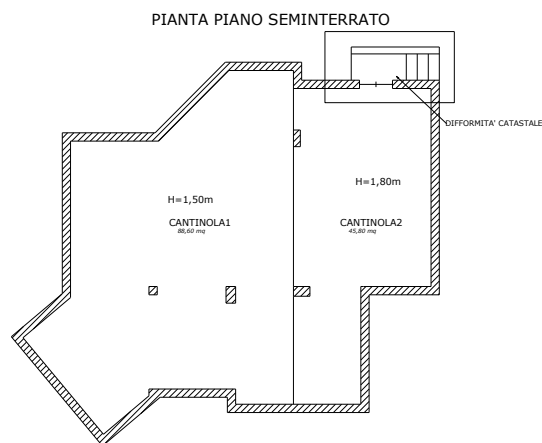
planimetria delle difformità catastali del piano seminterrato della villa
